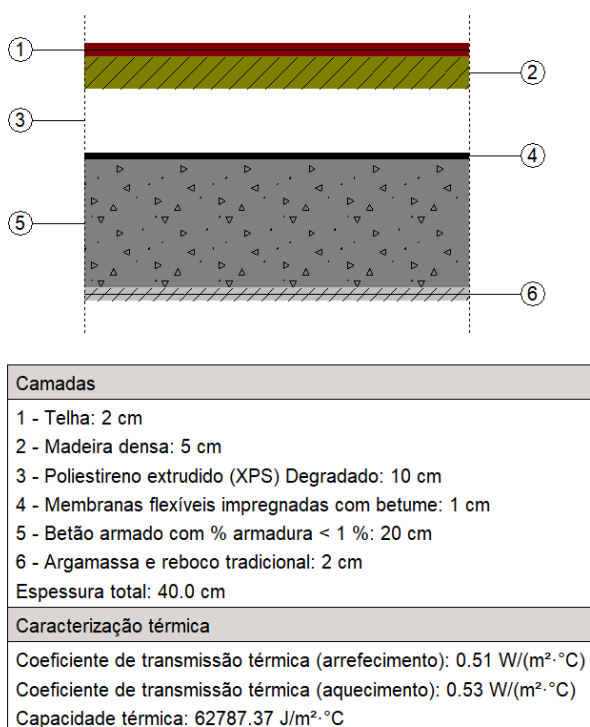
Vista de corte da cobertura da situação inicial com degradação
